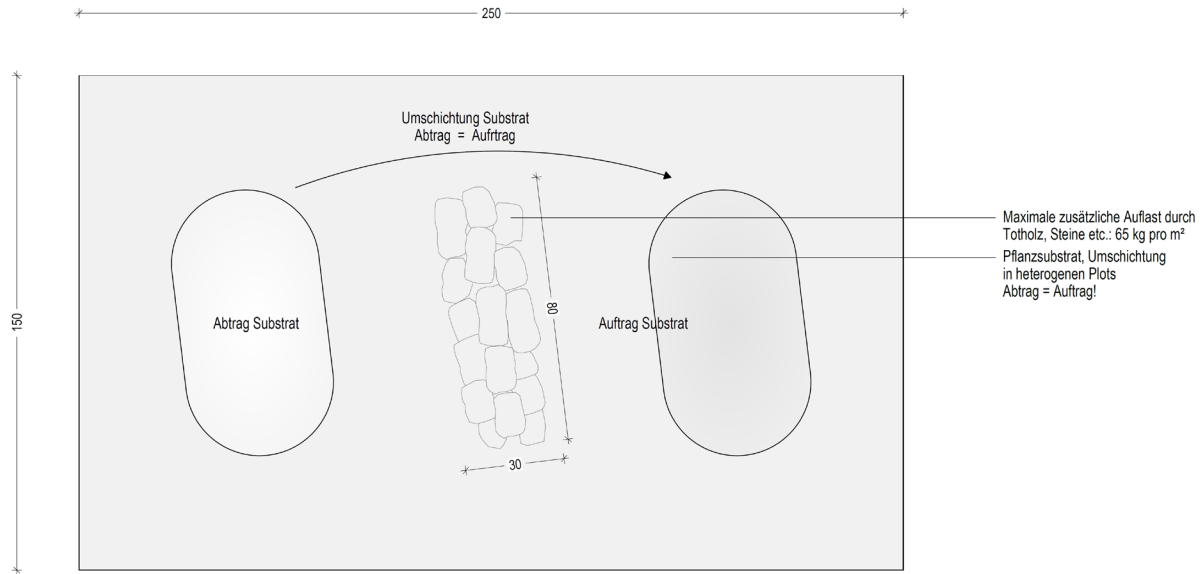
Ausschnitt aus Detailplan Versuchsflächen Dachexperiment
